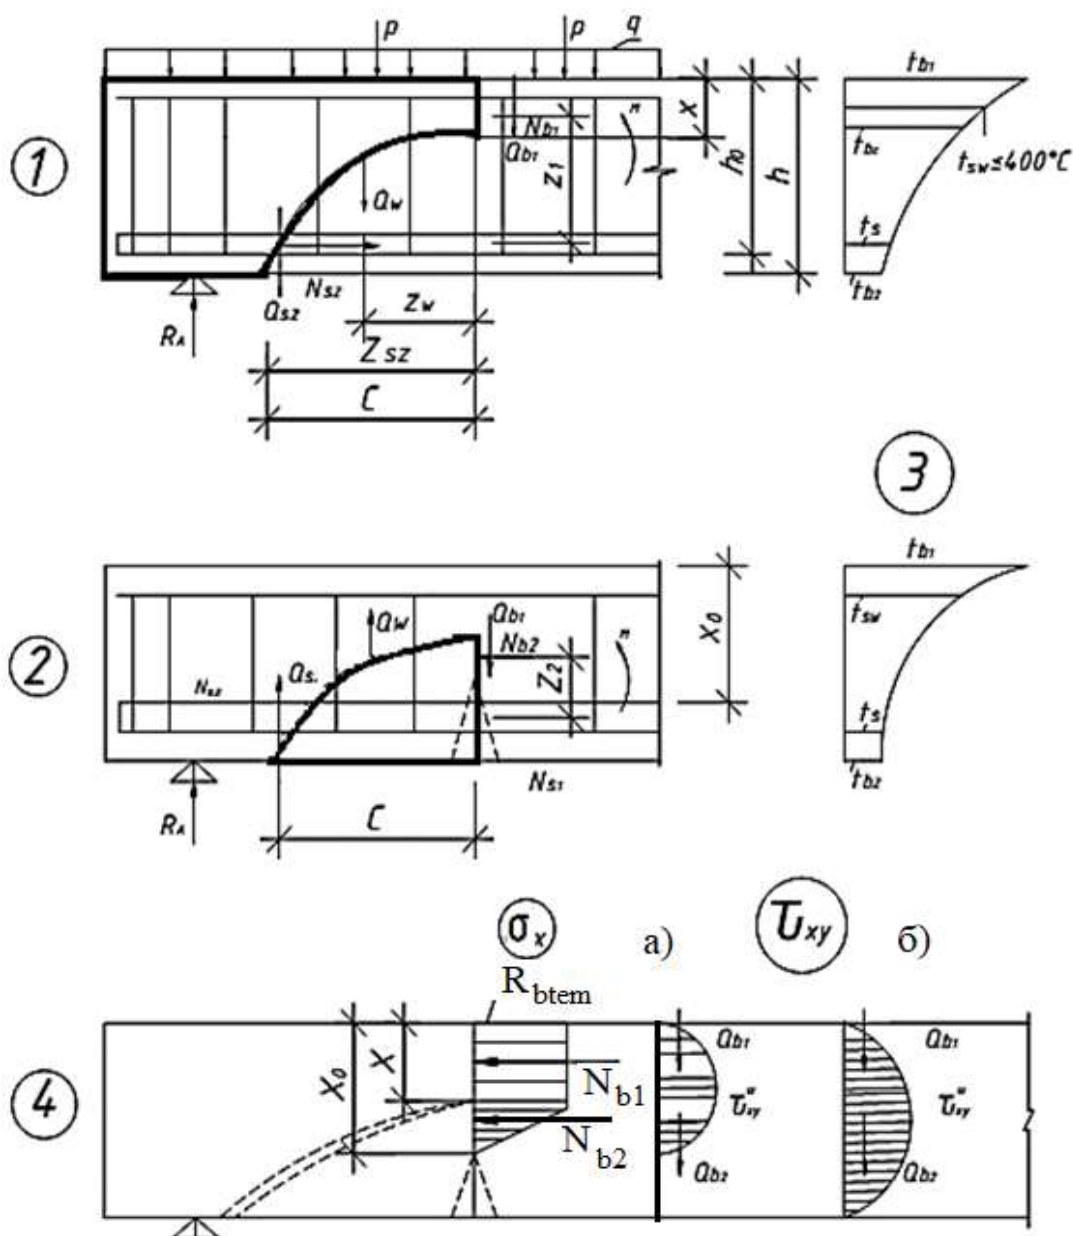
Расчетная схема усилий в наклонном сечении железобетонного элемента при одностороннем нагреве: 1 - в верхнем блоке 2 - в нижнем блоке; 3 - распределение температуры по высоте сечения; 4 - расчетные эпюры напряжений в бетоне; а - в элементах без поперечной арматуры, б - с хомутами.
